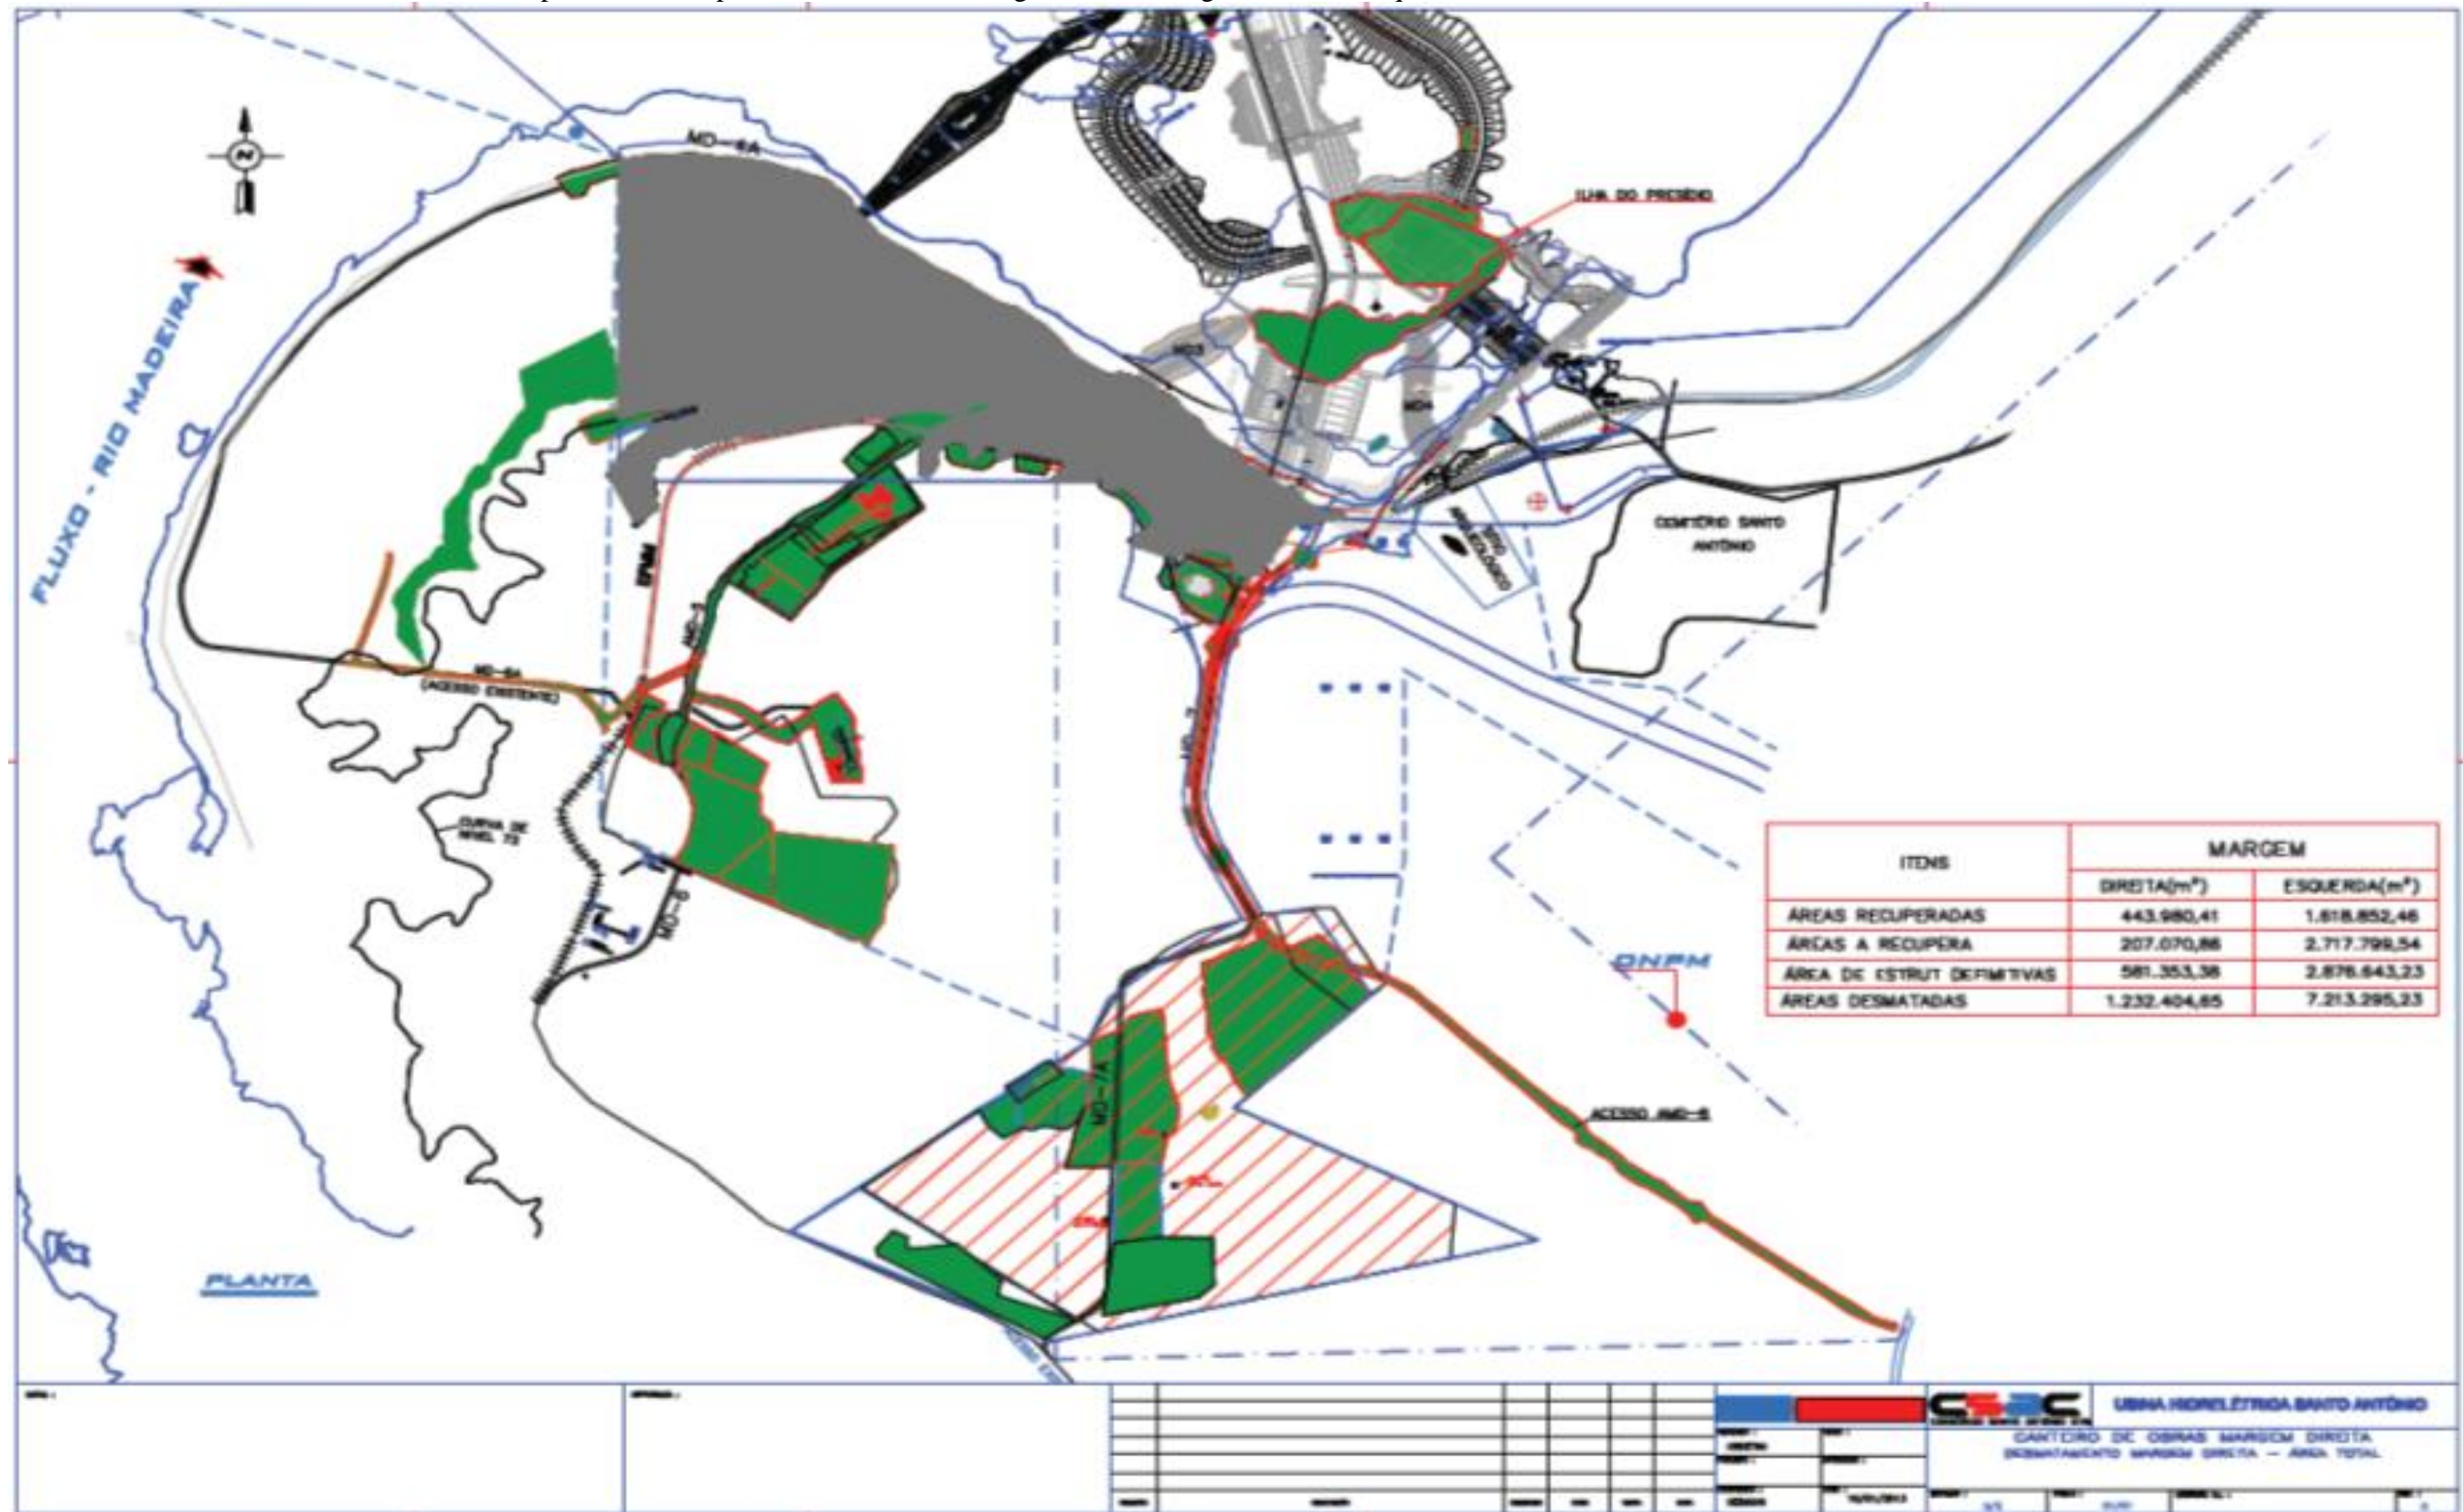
10 - Planta da margem direita do canteiro de obras com a área revegetada até o mês de janeiro de 2013.
